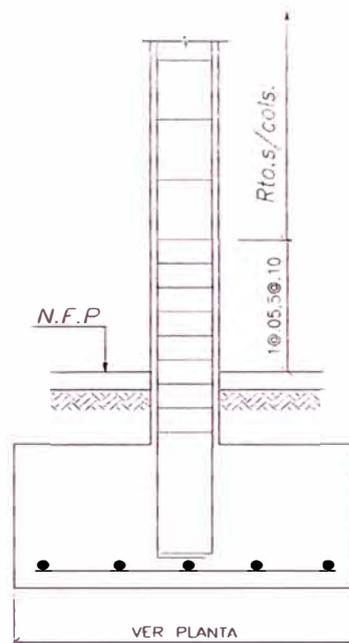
Detalle Representativo De Zapata Típica Aislada
